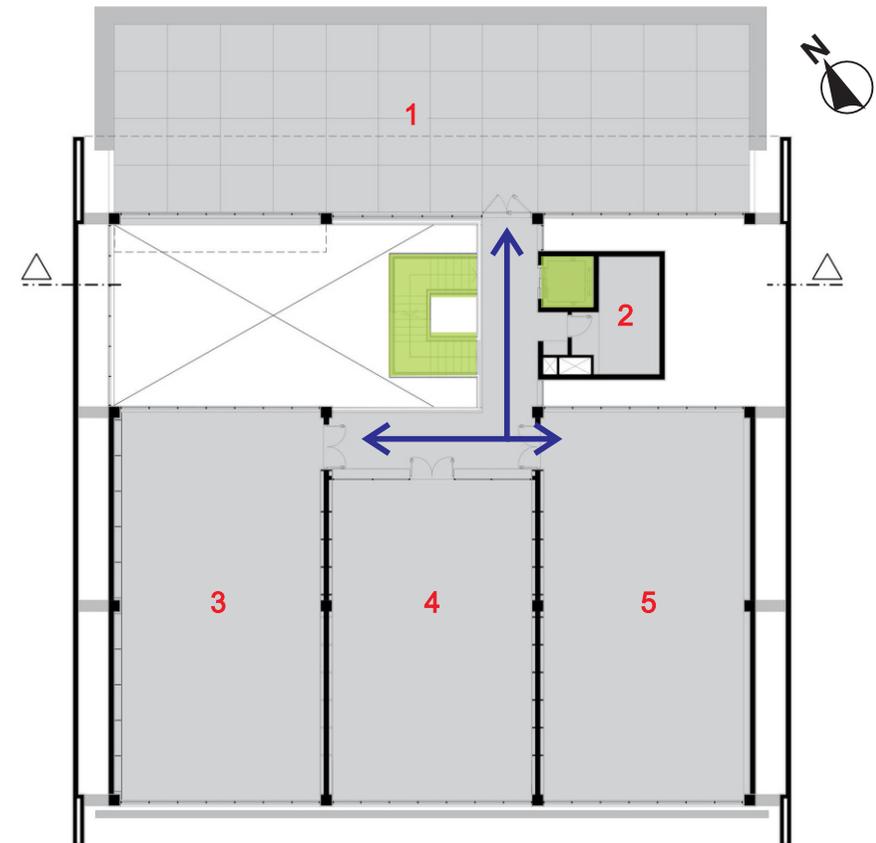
Planta baixa 3º pavimento. Fonte: Site Archdaily
